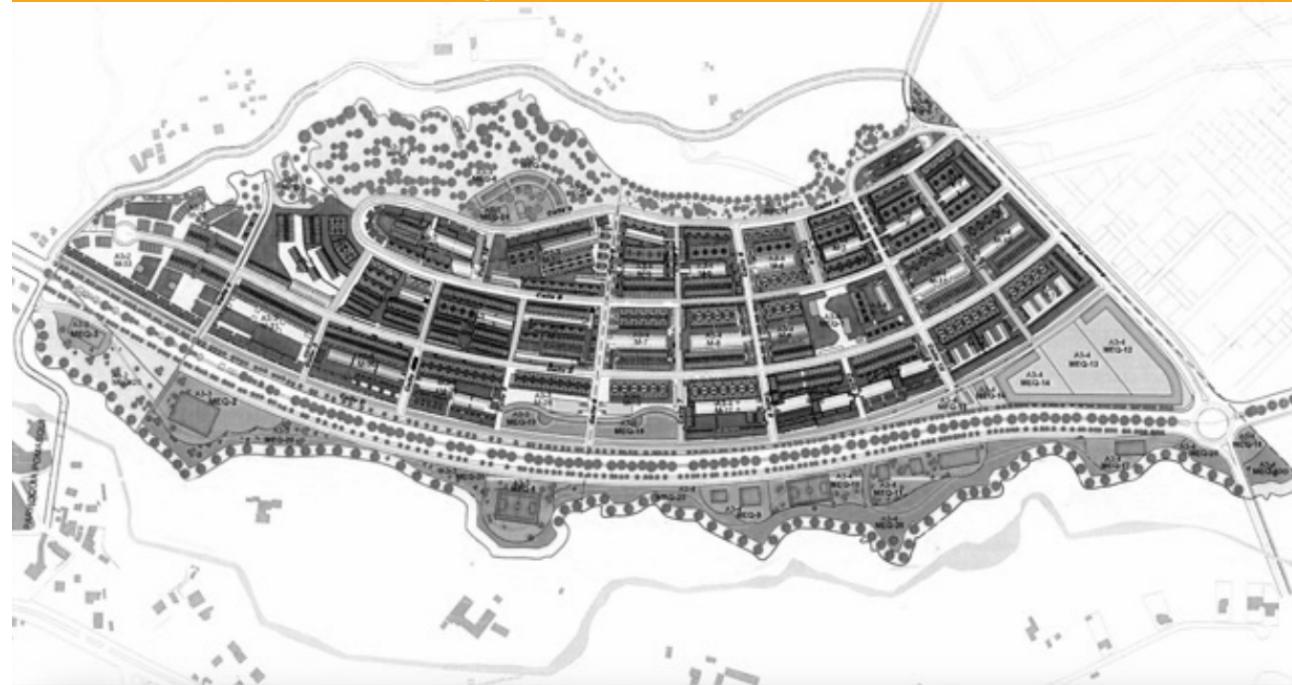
Uso y tipo de edificación, Proyecto Ciudad Bicentenario. Fuente: ORDENANZA METROPOLITANA No. 02 31 (Ordenanza Metropolitana No. 0231, 2018).
